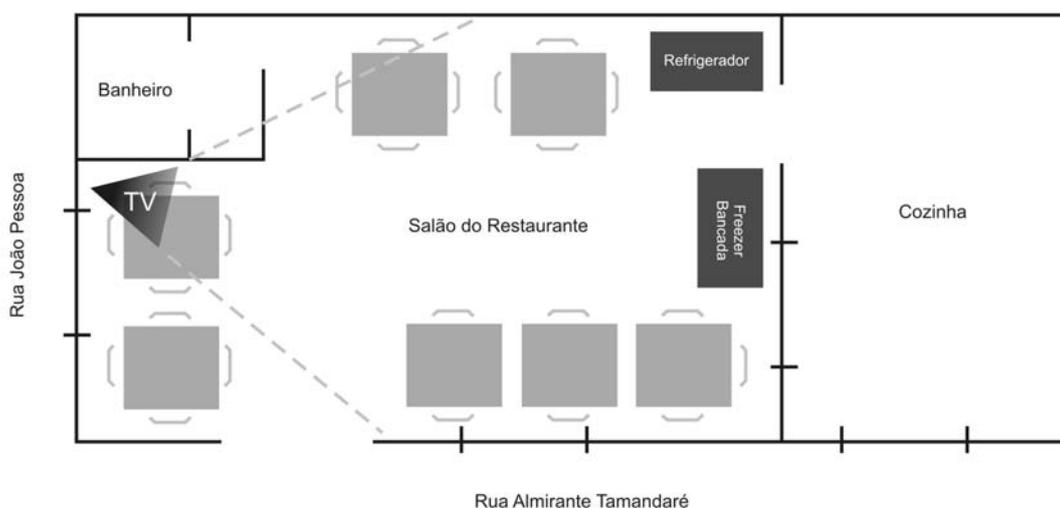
Croqui do interior do Restaurante Q'Sabor com a posição do televisor
